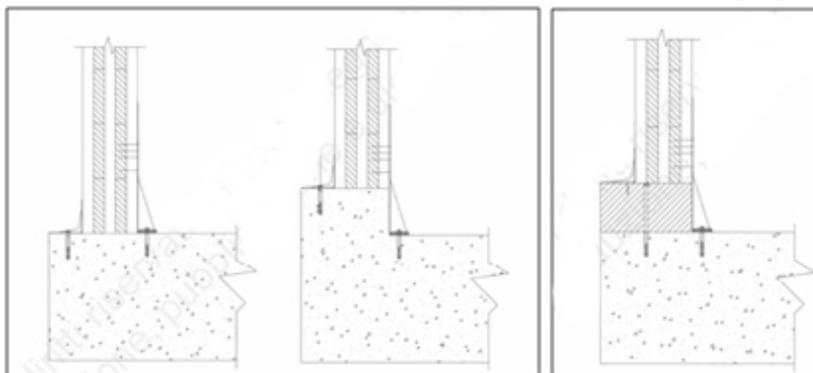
Collegamenti parete perimetrale -struttura di fondazione.
